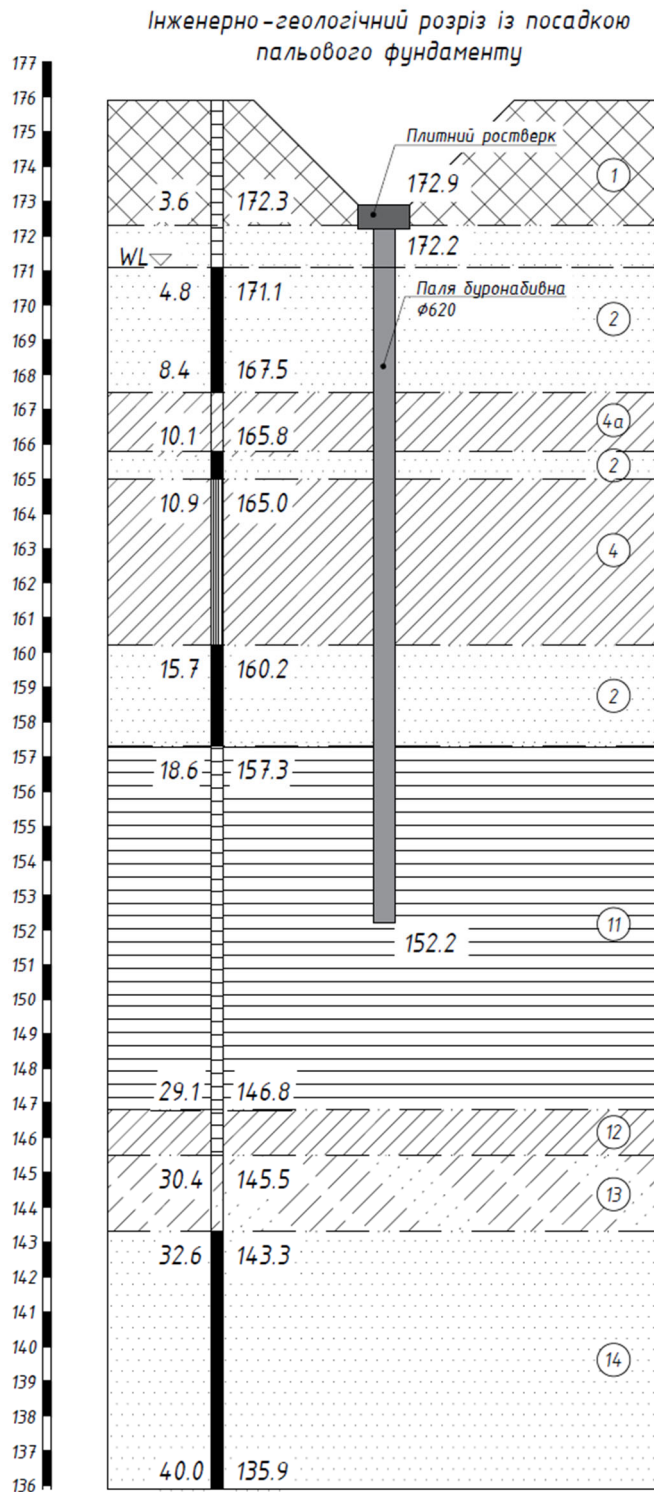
Інженерно-геологічний розріз із посадкою фундаменту
